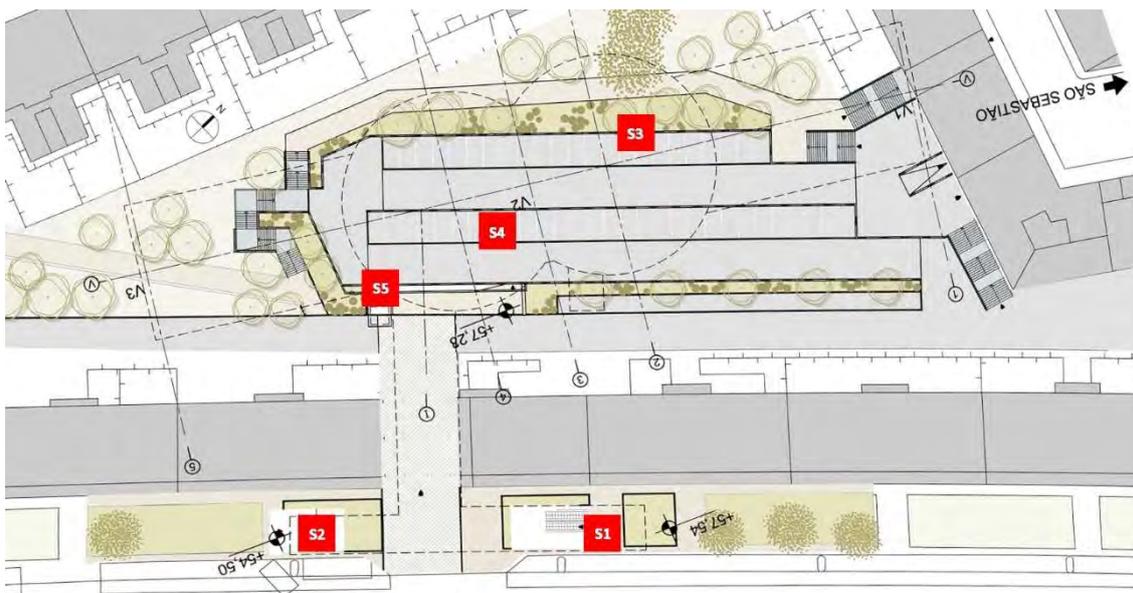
Localização das mesmas 5 sondagens sobre a planta de projeto.
